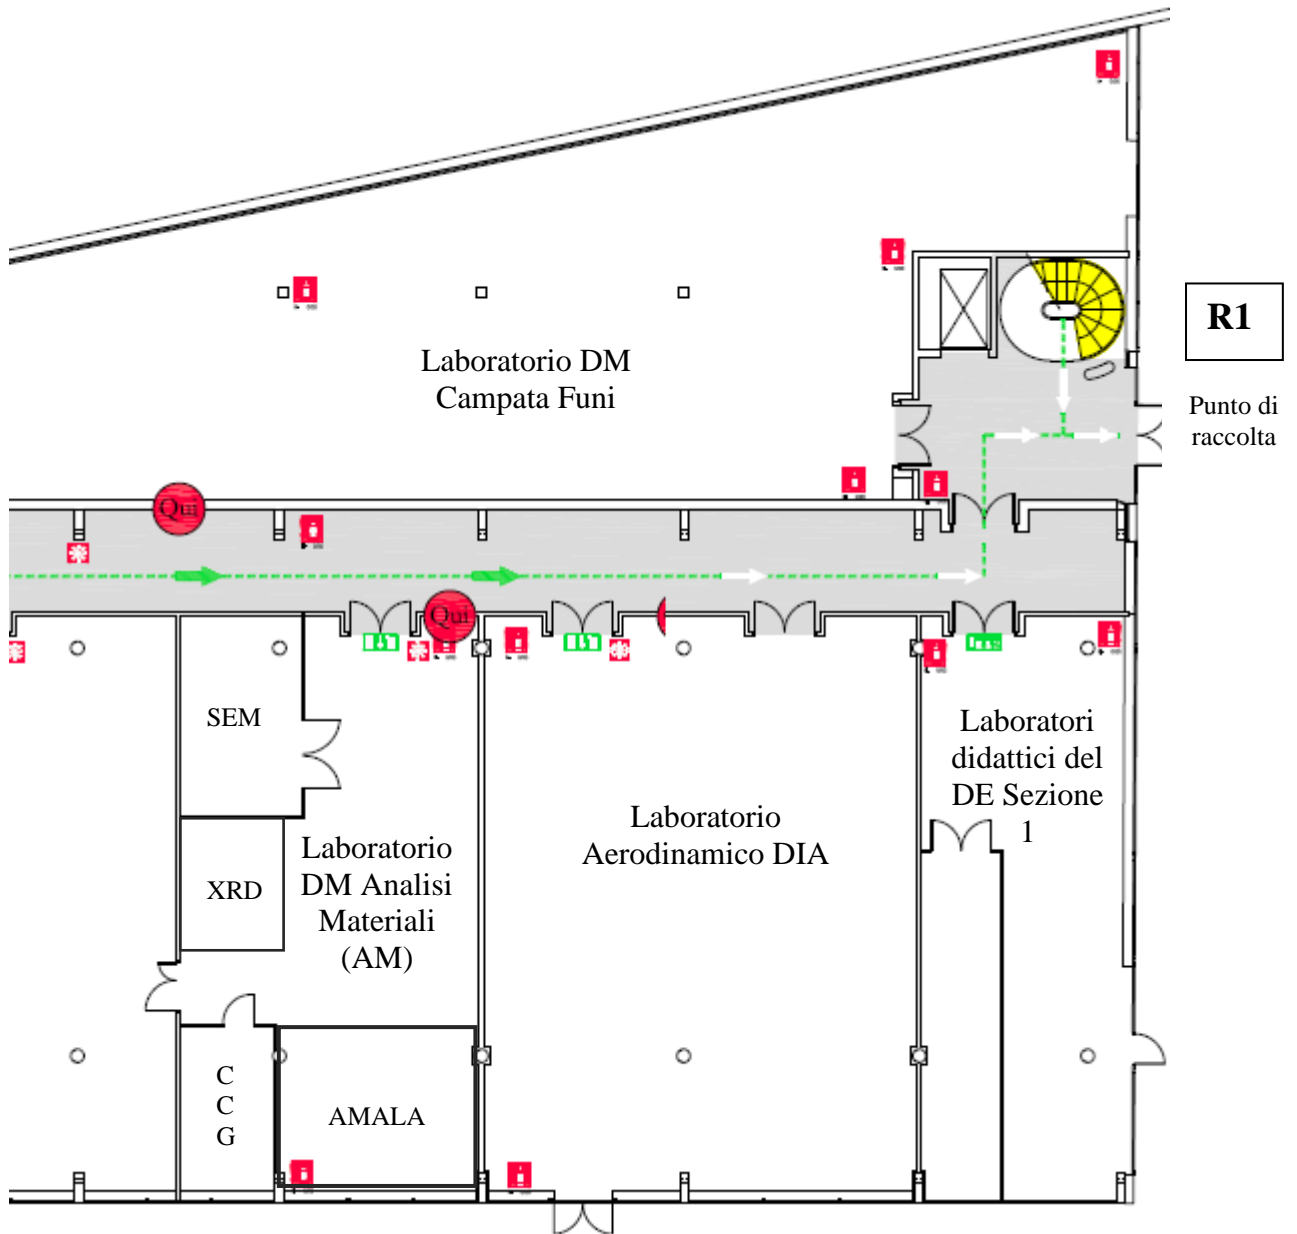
Pianta dell'edificio B13 - Piano Terra (Parte I)
